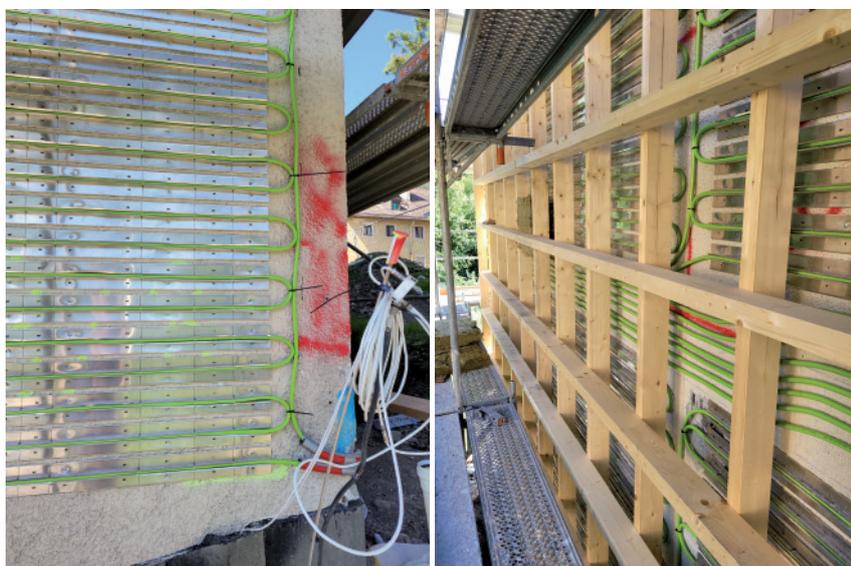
Nachträglich installierte Bauteilaktivierung der Außenwand. Links: Heizschlangen mit Wärmeleitblechen (System CEPA) Rechts: Kreuzlagen in Holzbauweise, welche mit Dämmstoff gefüllt werden.
